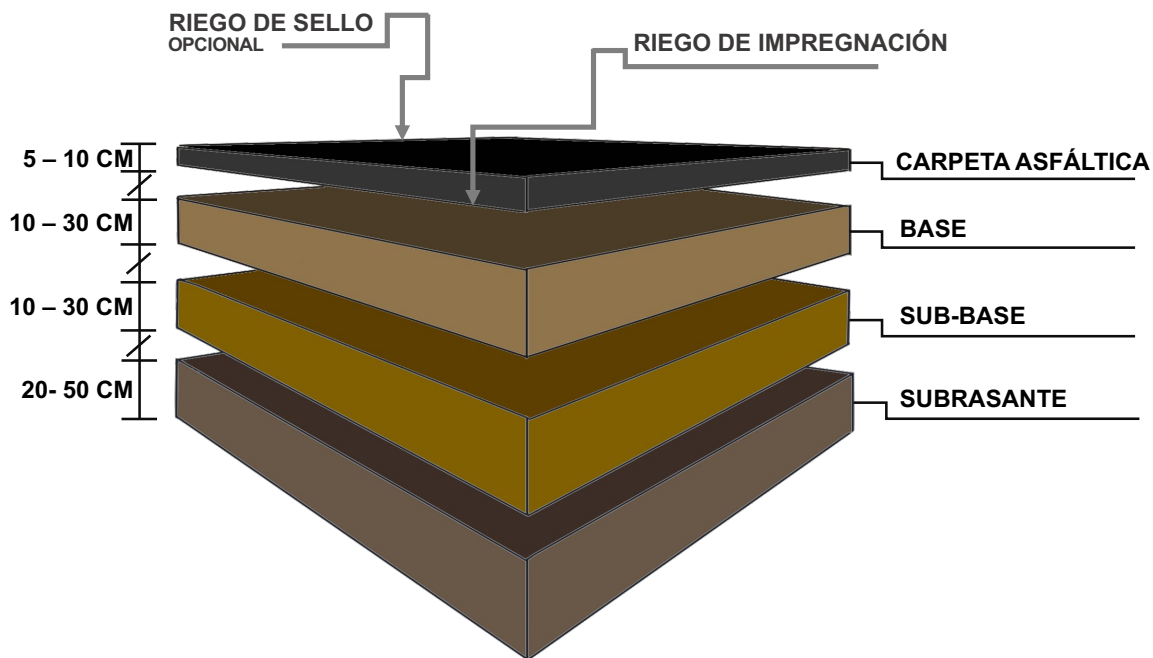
Estructura del Pavimento Flexible. Fuente: Elaboración Propia.
